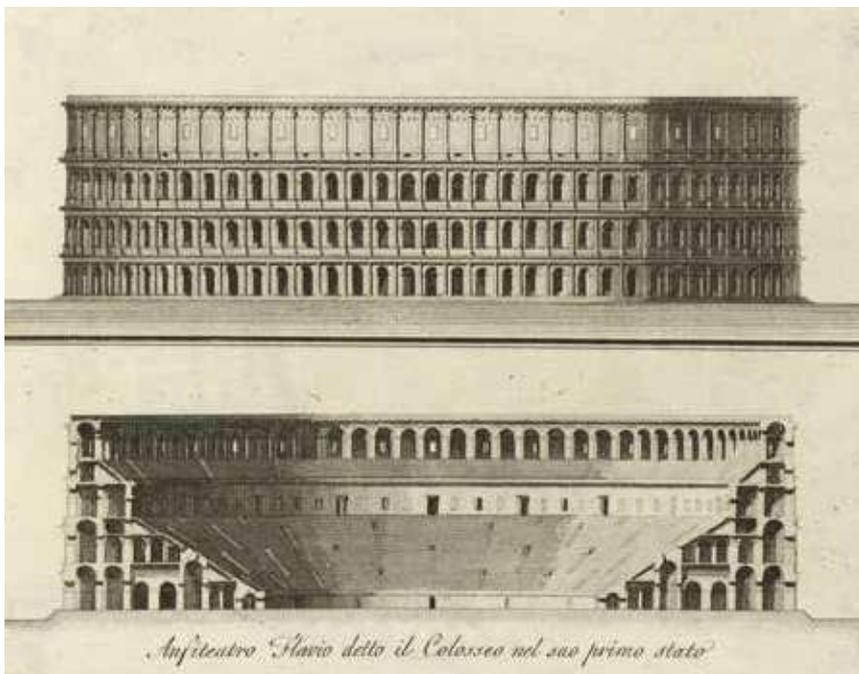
Rekonstruktion Kolosseum, Aufriss und Schnitt, Stich Pietro Piale nach 1805
